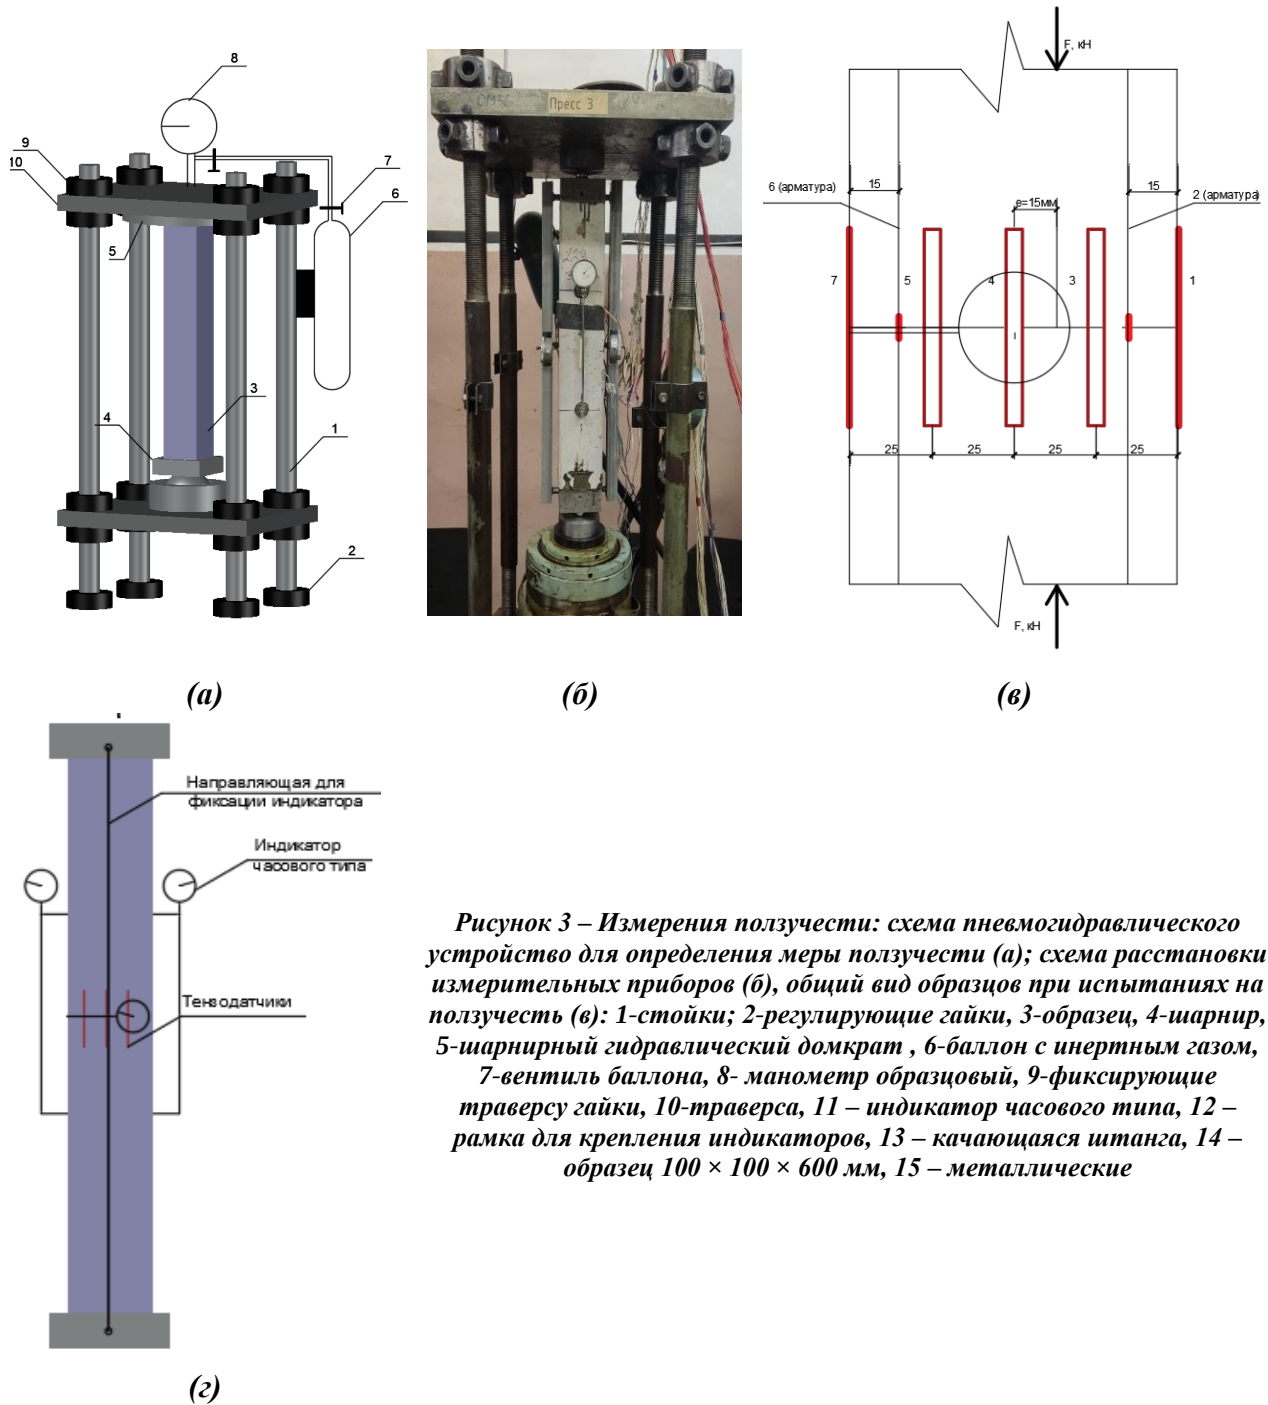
Измерения ползучести: схема пневмогидравлического устройство для определения меры ползучести (а); схема расстановки измерительных приборов (б), общий вид образцов при испытаниях на ползучесть (в): 1-стойки; 2-регулирующие гайки, 3-образец, 4-шарнир, 5-шарнирный гидравлический домкрат, 6-баллон с инертным газом, 7-вентиль баллона, 8- манометр образцовый, 9-фиксирующие траверсу гайки, 10-траверса, 11 – индикатор часового типа, 12 – рамка для крепления индикаторов, 13 – качающаяся штанга, 14 – образец $100 \times 100 \times 600$ мм, 15 – металлические
